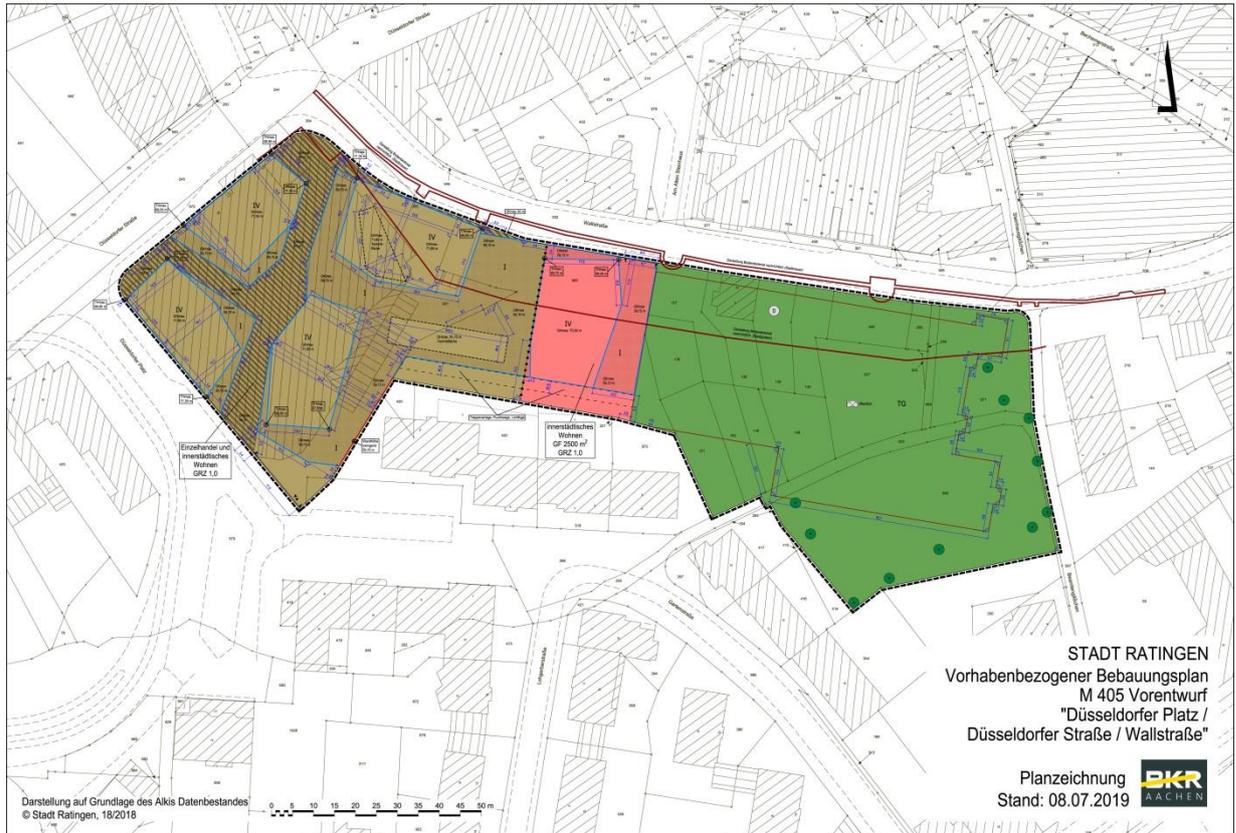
Bebauungsplan M 405 – Planzeichnung (verkleinert).
